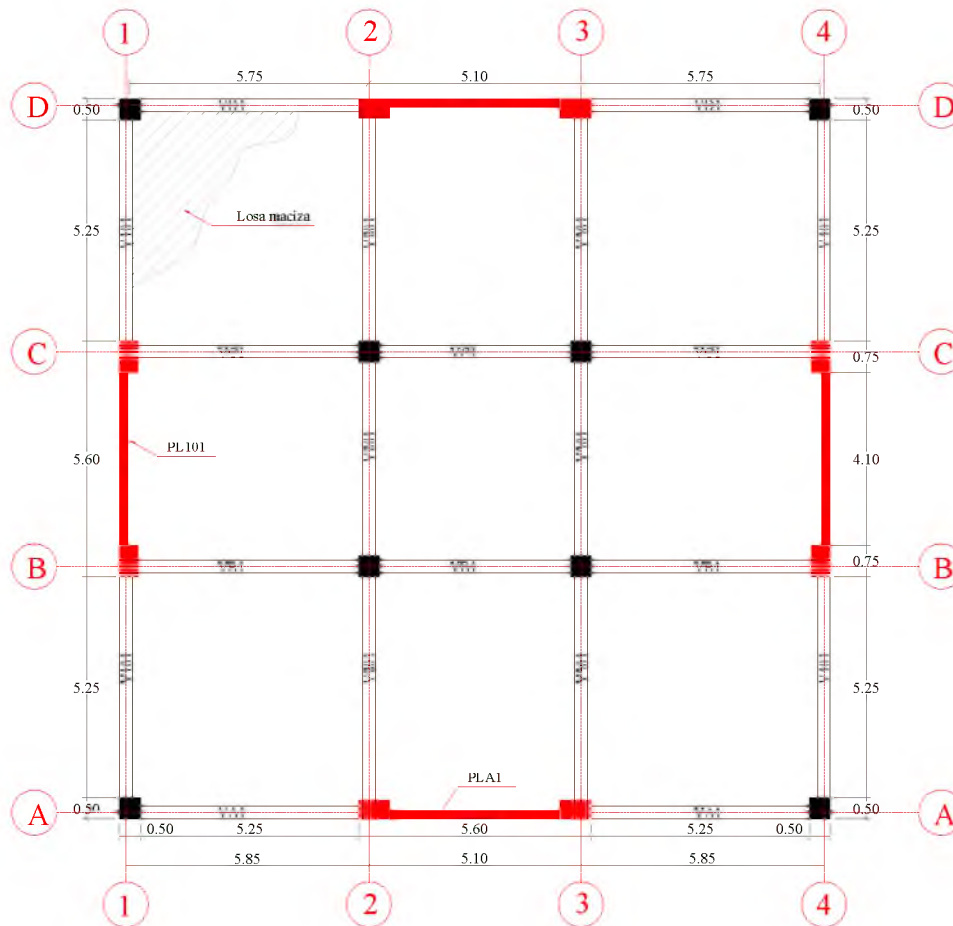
Vista en planta de la edificación de ocho niveles
